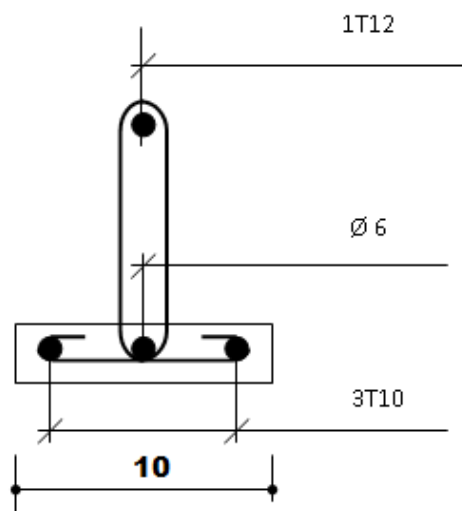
Ferraillages de la poutrelle (En travées)
